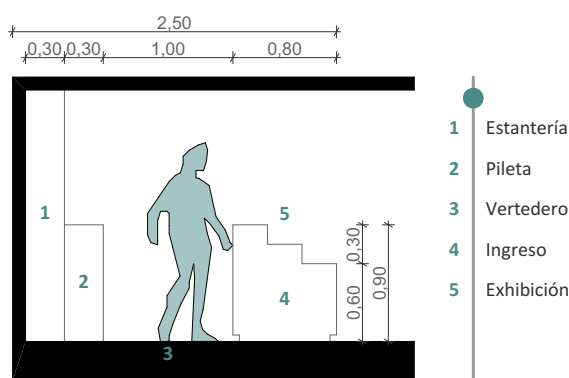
Sección puesto de flores. Fuente: Autores.
